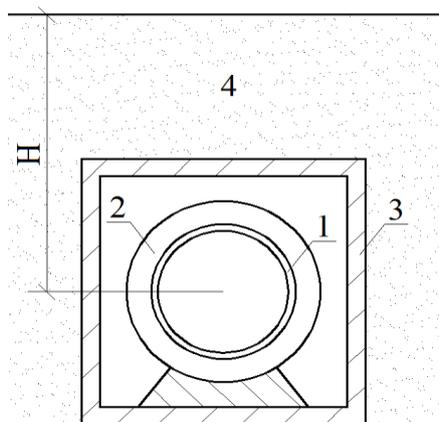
Схематическое расположение трубопровода в непроходном одноячейковом канале подземной прокладки. Н - глубина залегания к горизонтальной оси; 1 - металлическая стенка трубы; 2 – слой изоляции; 3 – железобетонная стенка канала; 4 - грунт.
